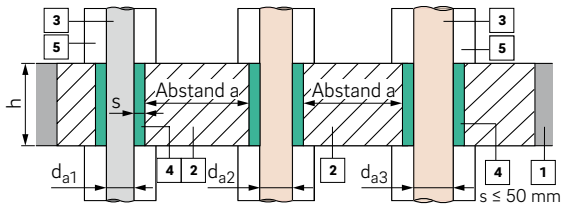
Rohre in Dämmung – gemeinsame Öffnung
